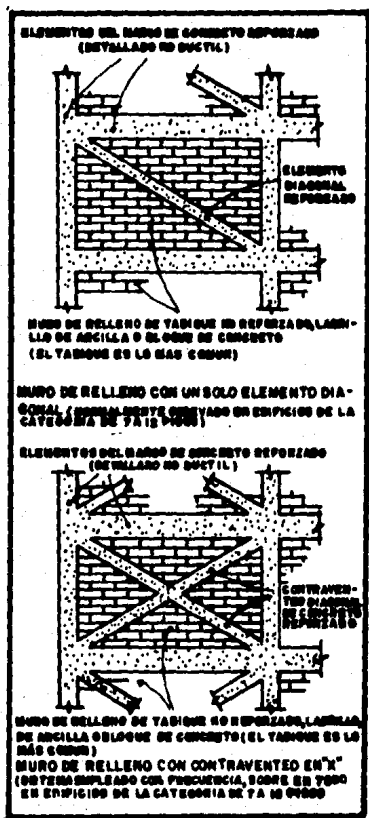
(1) Tipo de Contraventos utilizados en la Ciudad de México.
